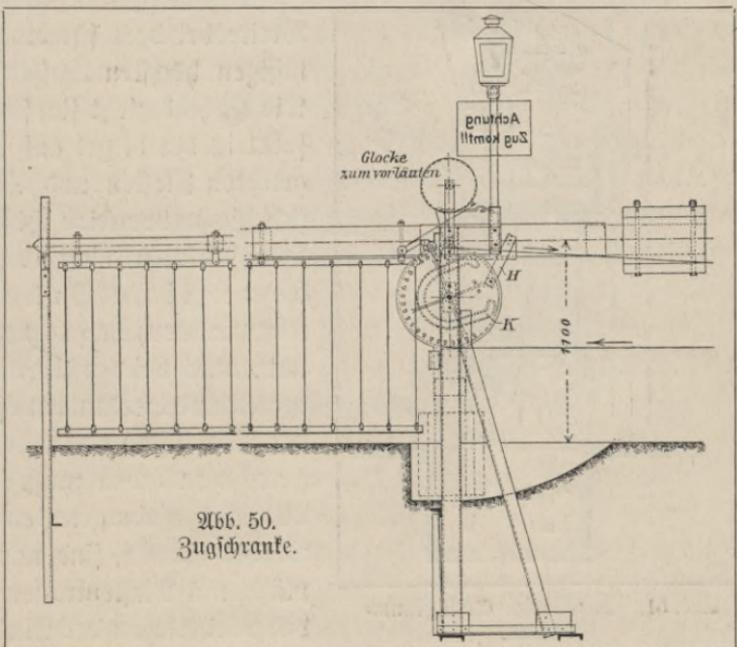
zeigt eine Zugschranke, die vom Winde-
